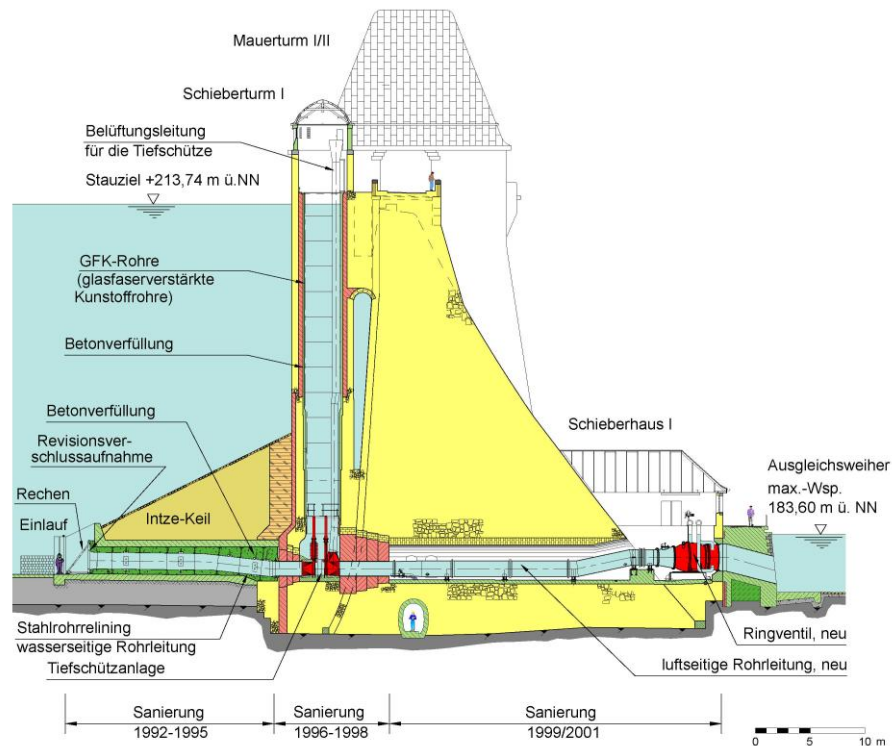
Längsschnitt Grundablass I - Sanierungsabschnitte
